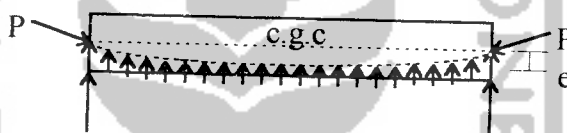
Pelat beton dengan menggunakan baja mutu tinggi
